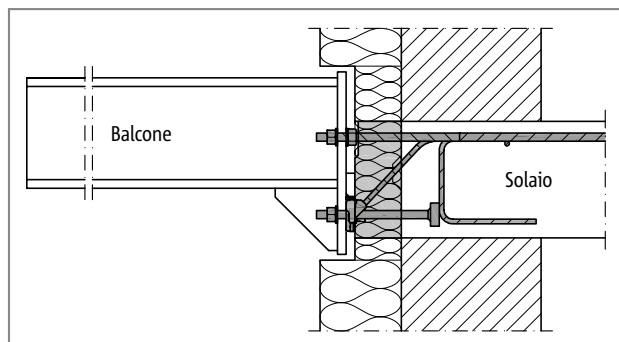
Schöck Isokorb® T tipo SKP: punto di passaggio privo di barriere mediante salto di quota
